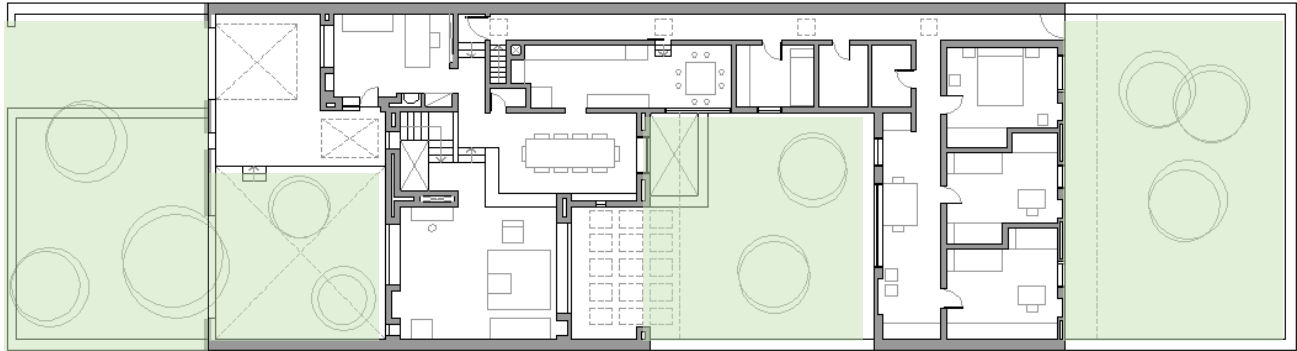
planta baixa redesenhada do pavimento superior. O acesso principal, pela escada, situa-se no centro dos ambientes sociais. Em verde, pátios.
